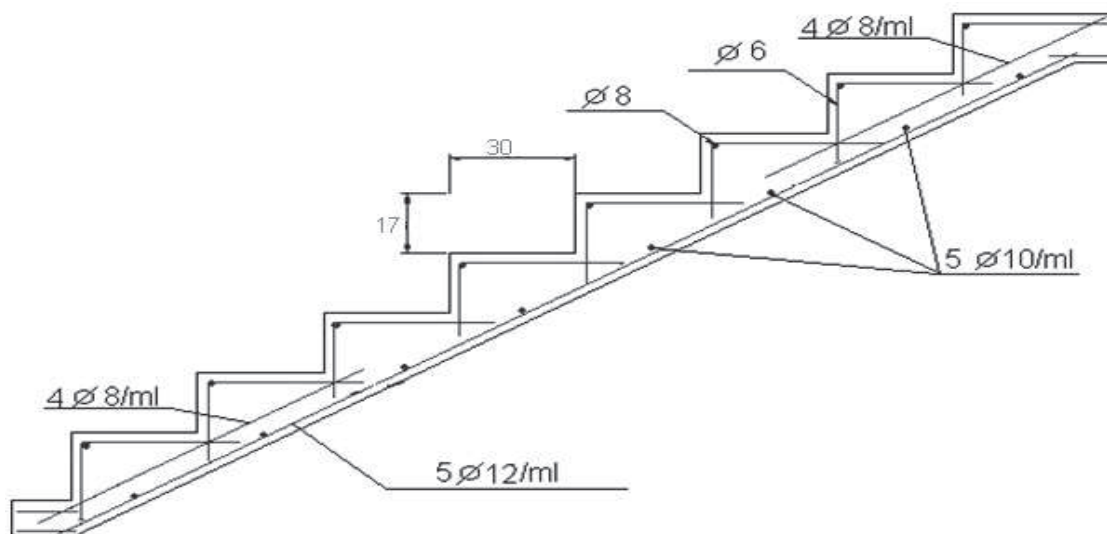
Ferrailage de la partie III de l'escalier type 3
